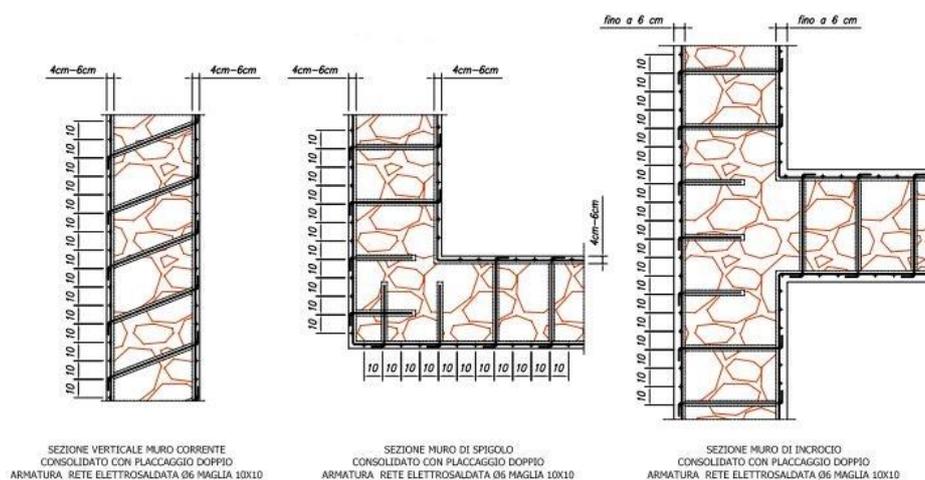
Tecnica di consolidamento con intonaco armato con rete elettrosaldata
